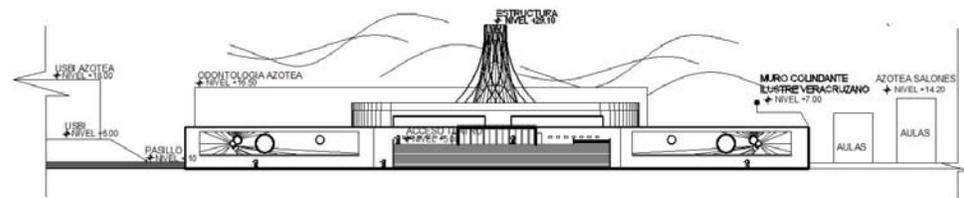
, vista en donde se aprecia la fachada principal interactuar con su contexto arquitectónico.
